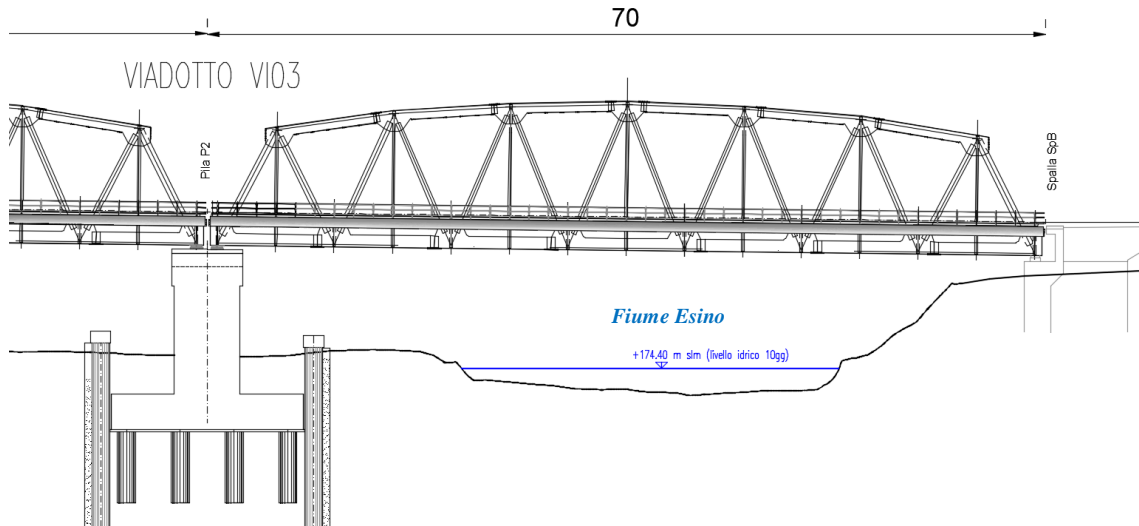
Prospetto del viadotto VI03: livello idrico di cantiere e opere provvisionali.
